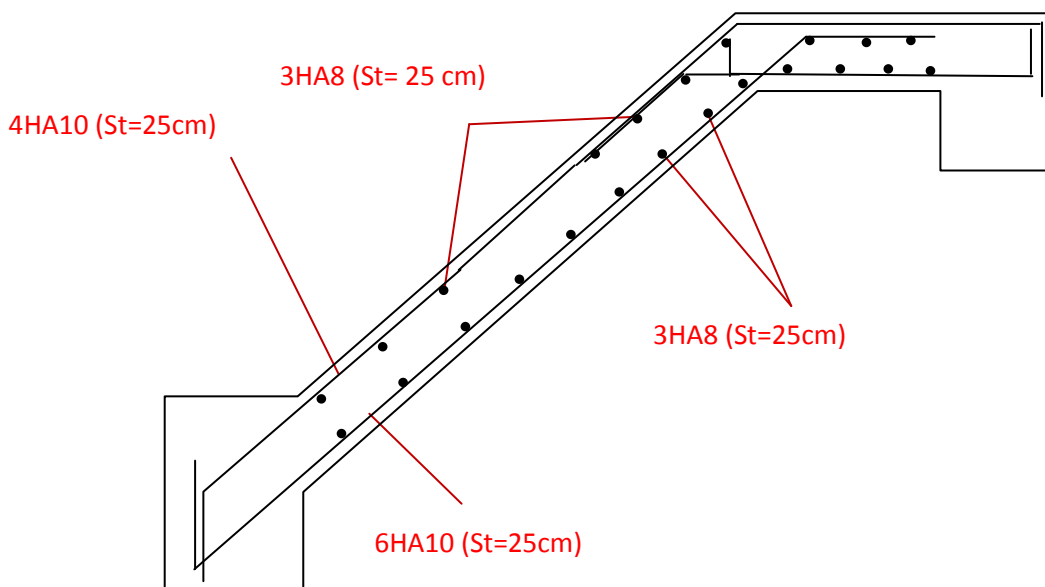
Schéma de ferrailage d'escalier type III (volée 2)
